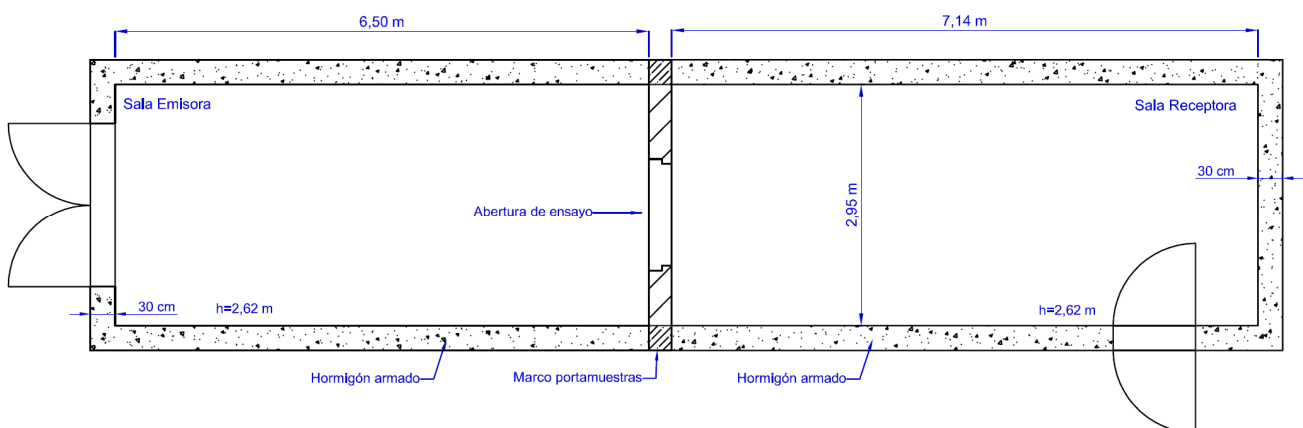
Croquis esquemático de las salas de ensayo (vista en planta)
